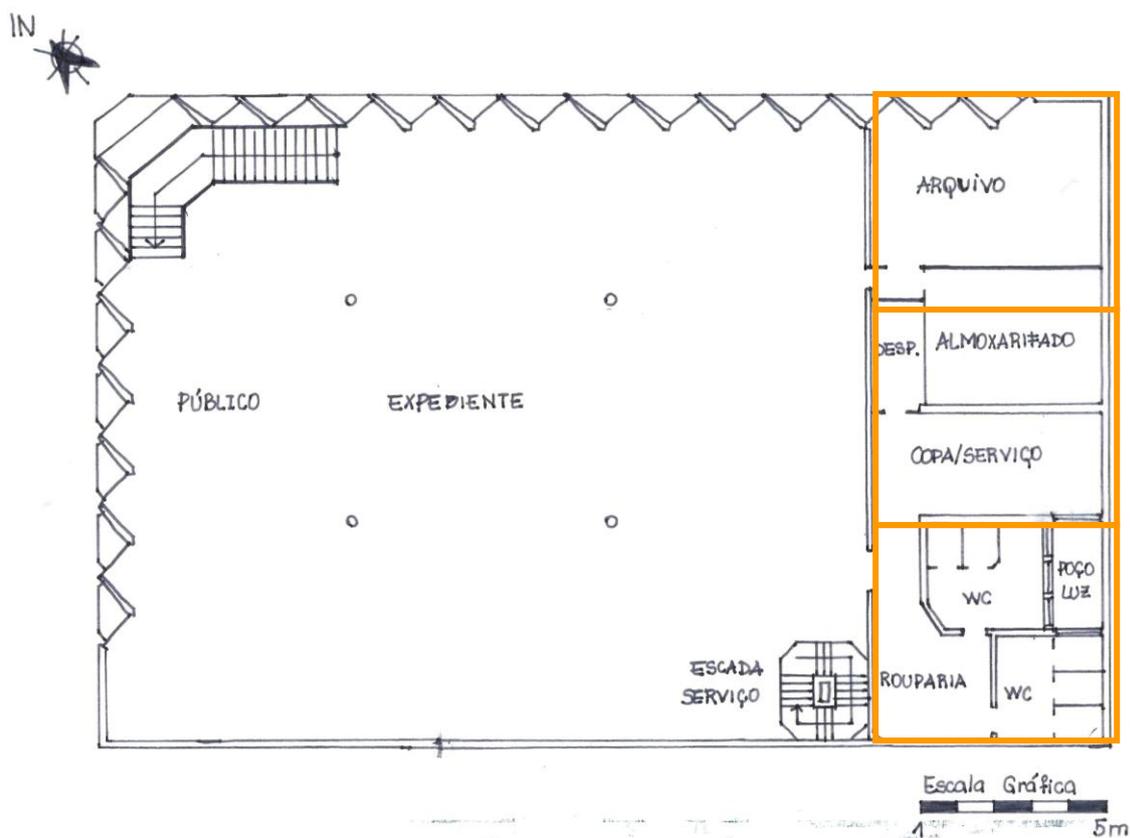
Planta baixa esquemática da edificação – Segundo Pavimento.
